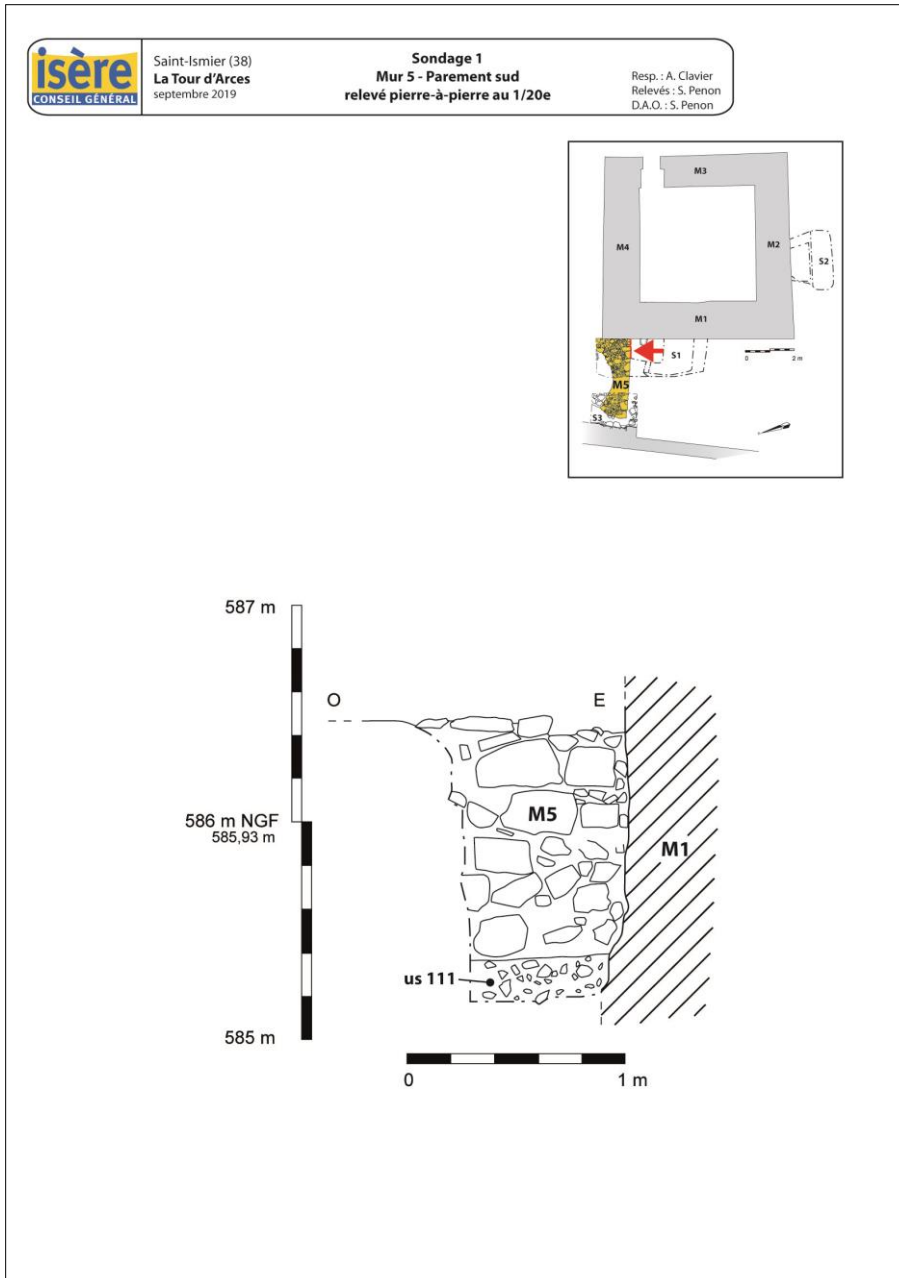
relevé pierre à pierre du parement sud du mur M05. Relevé et DAO Séverine Penon.
